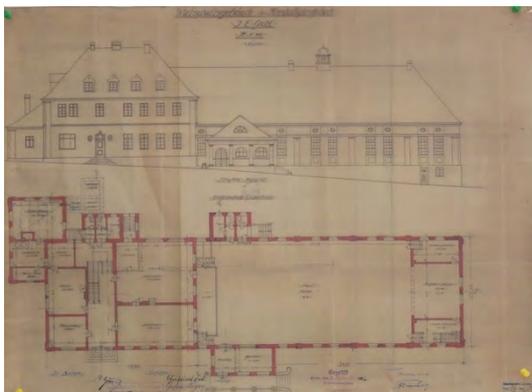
Grundriss Erdgeschoss + Ansicht Nord
